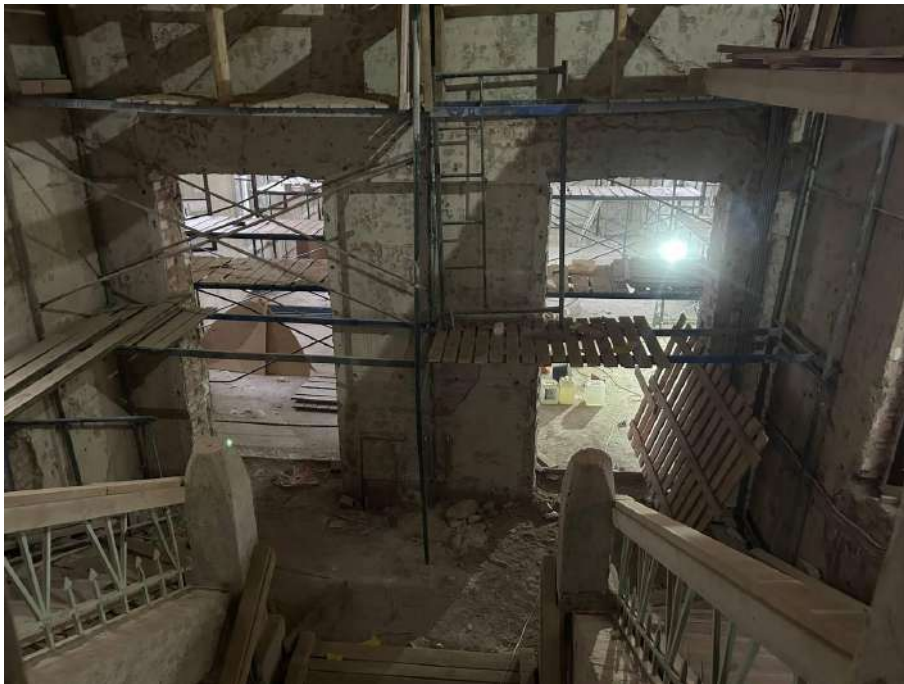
Вид на первый этаж со второго этажа, с главной лестницы.
